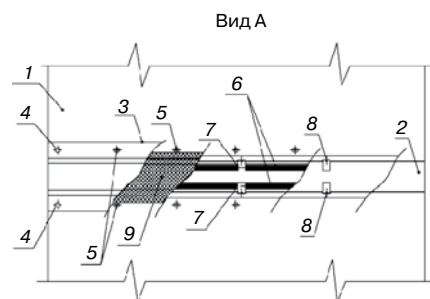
Фронтальный вид крепления устройства к конструкции стены
